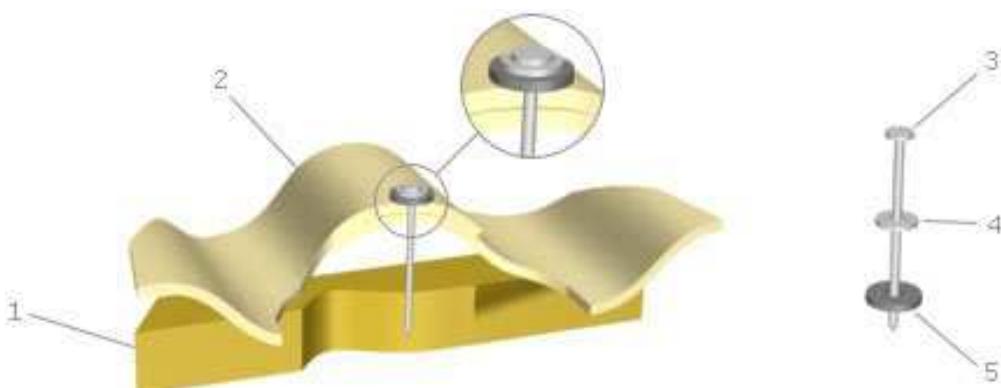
Крепление шифера на обрешётке: 1 – обрешётка; 2 – шифер; 3 – гвоздь или шуруп длиной 100 мм; 4 – шайба из металла; 5 – прокладка
